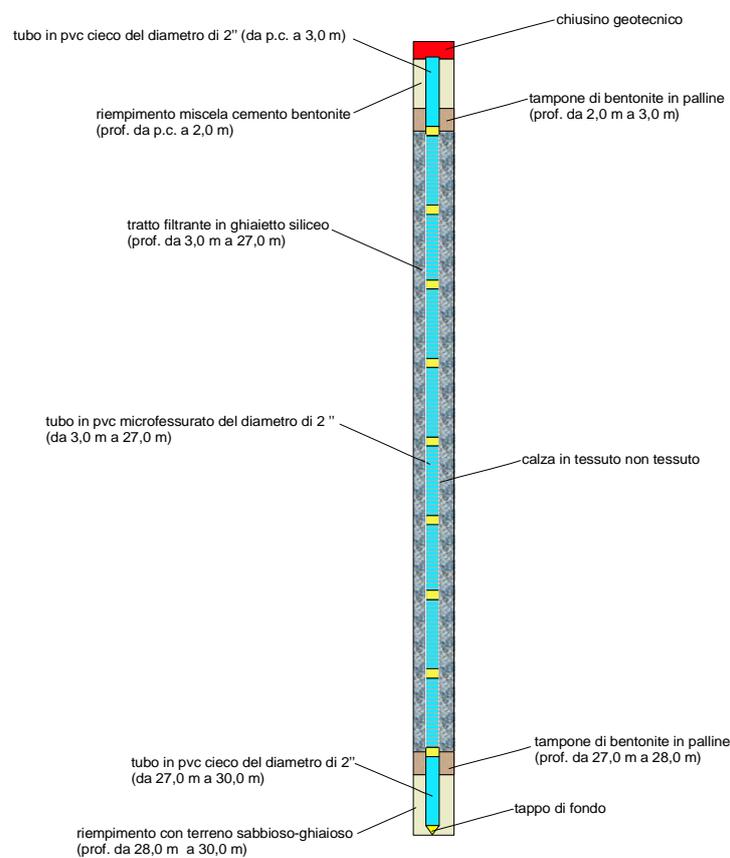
Schema tipo di piezometro a Tubo Aperto
